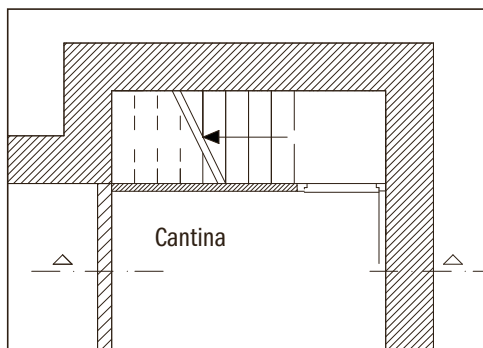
Planimetria accesso alla cantina (Fonte: SMUL).
